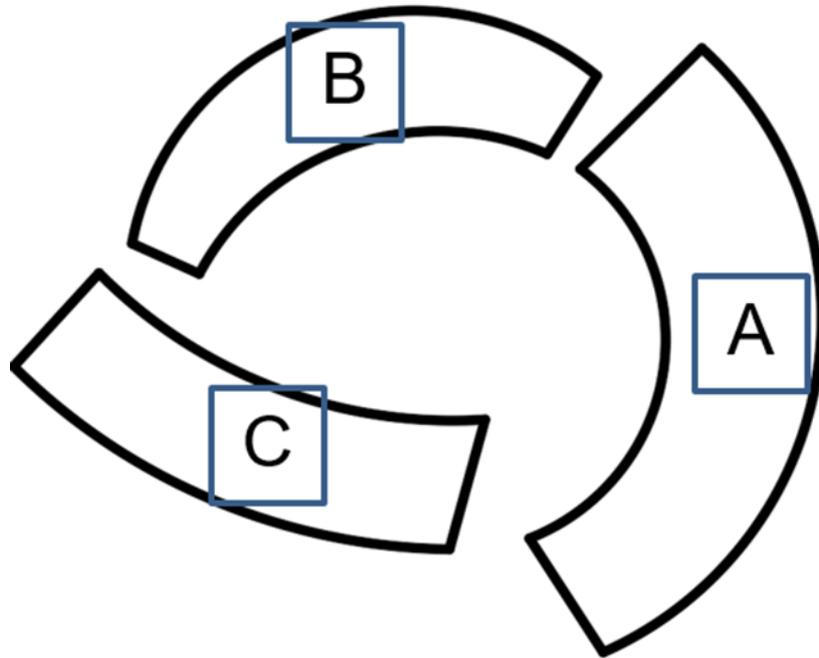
Plano conceptual de la Tercera Planta. Fuente: Elaboración propia
